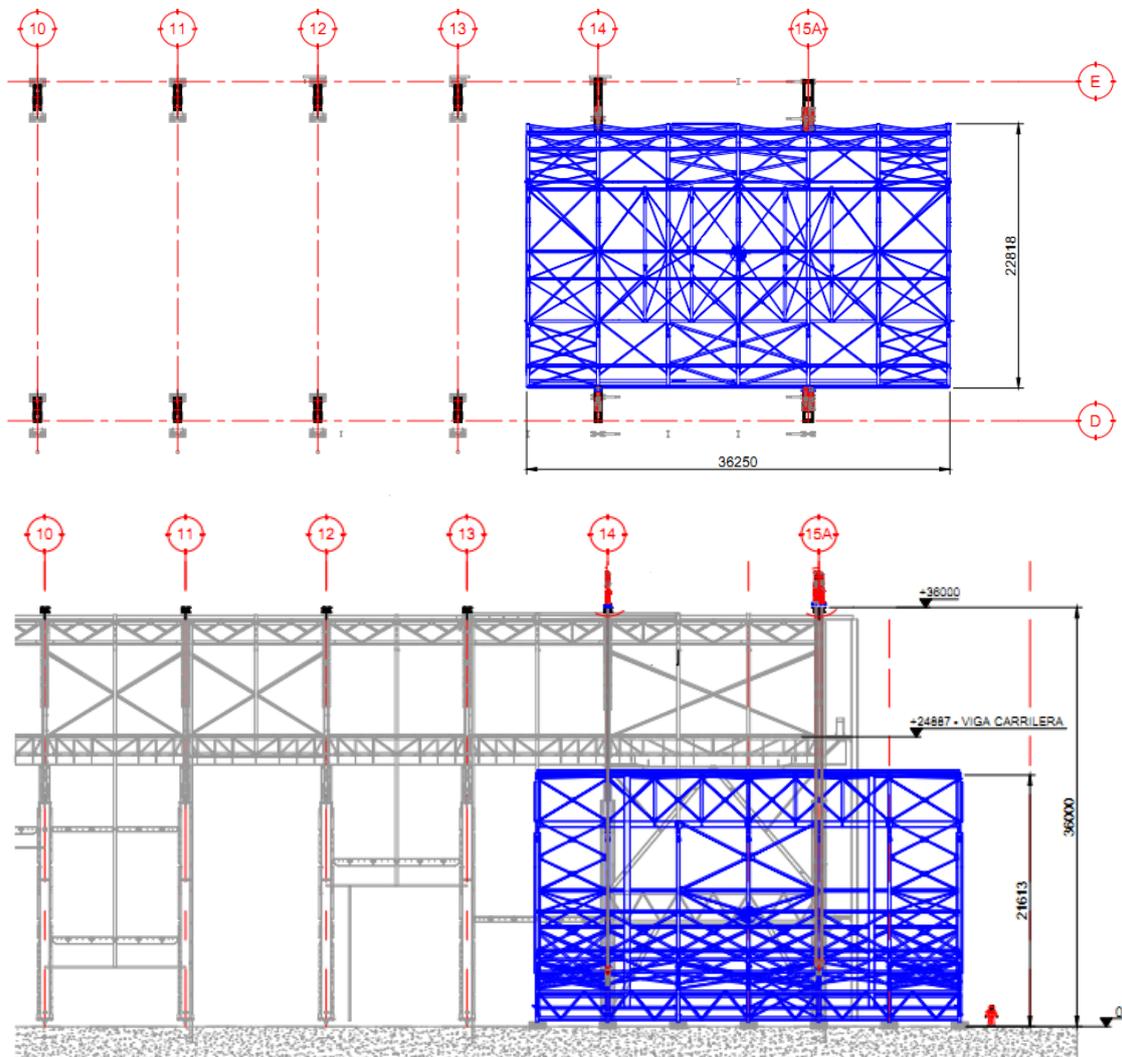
Ubicación en planta y vista lateral de la campana para el armado y primer izado.
